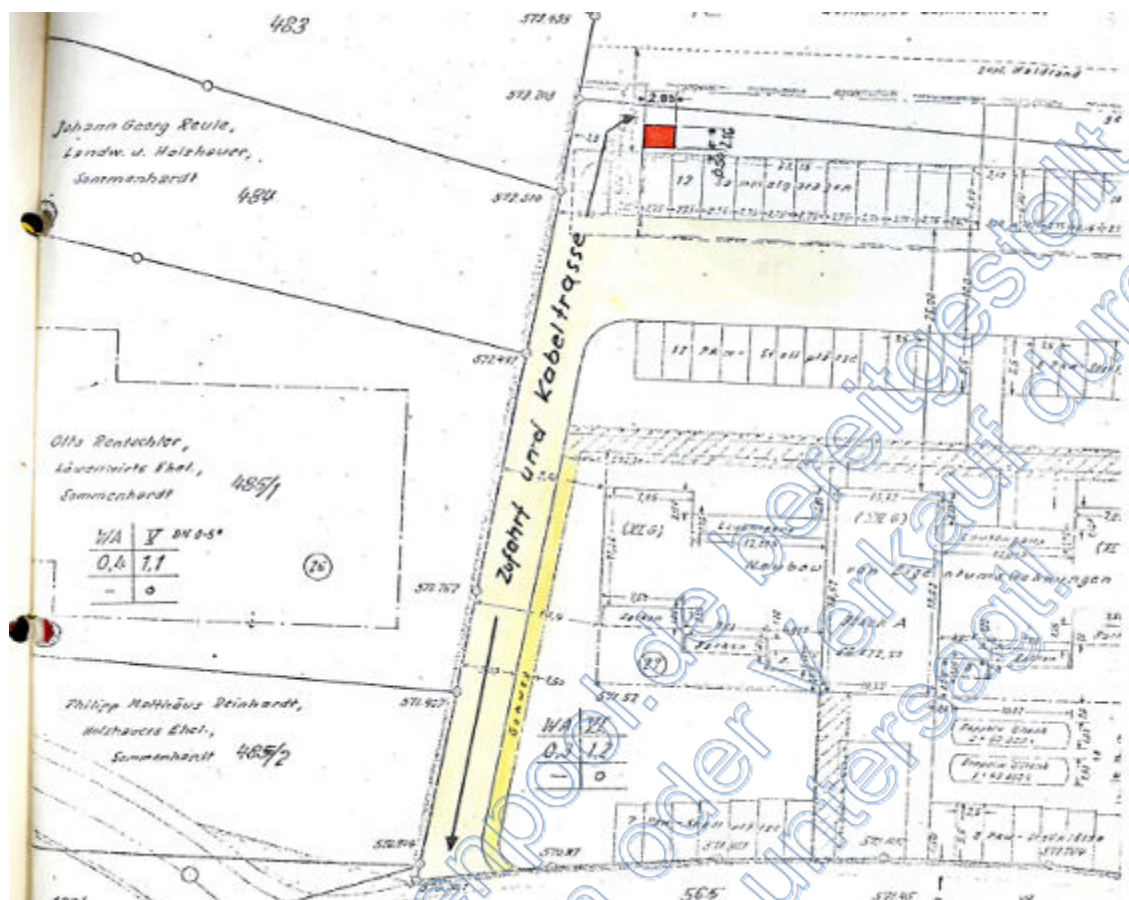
Lageplan zur Bewilligung UR Nr. 3826/1972; Quelle: Grundbuchzentralarchiv BW
